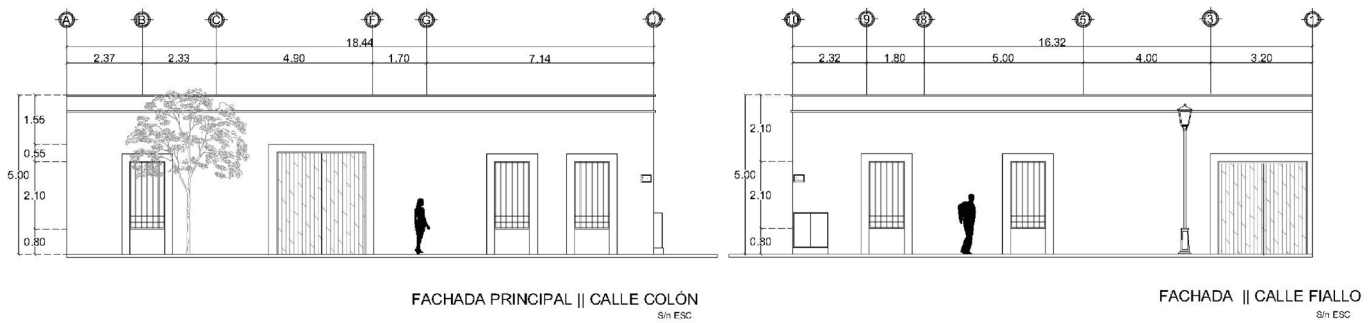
Propuesta de fachadas, arriba: fachada en la calle de Colón; y abajo: fachada en la calle de M. Fiallo, elaborado por el autor.
